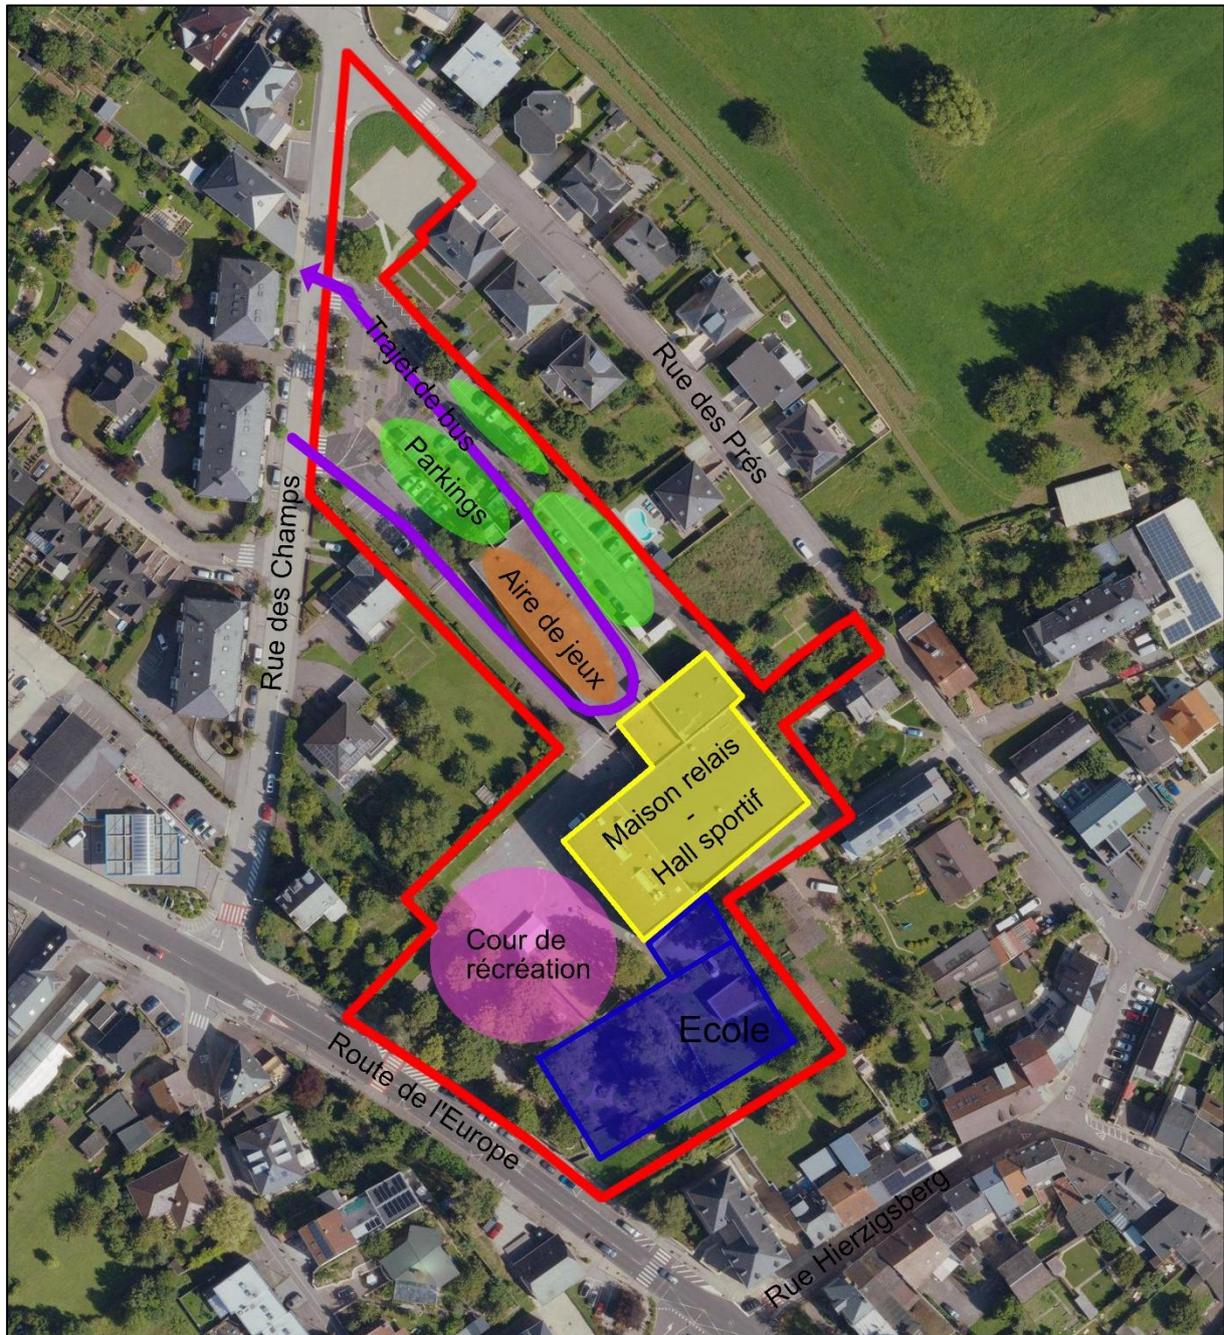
Plan de situation projetée et éléments existants (sans échelle, orientation Nord)
